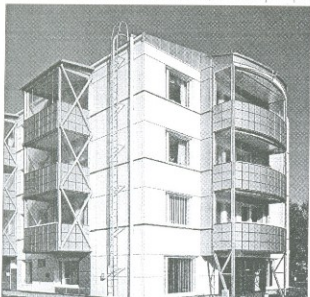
Реконструкция фасада выполнена с использованием металлических кассет. В торце пристроены новые балконы, опирающиеся на собственный фундамент
